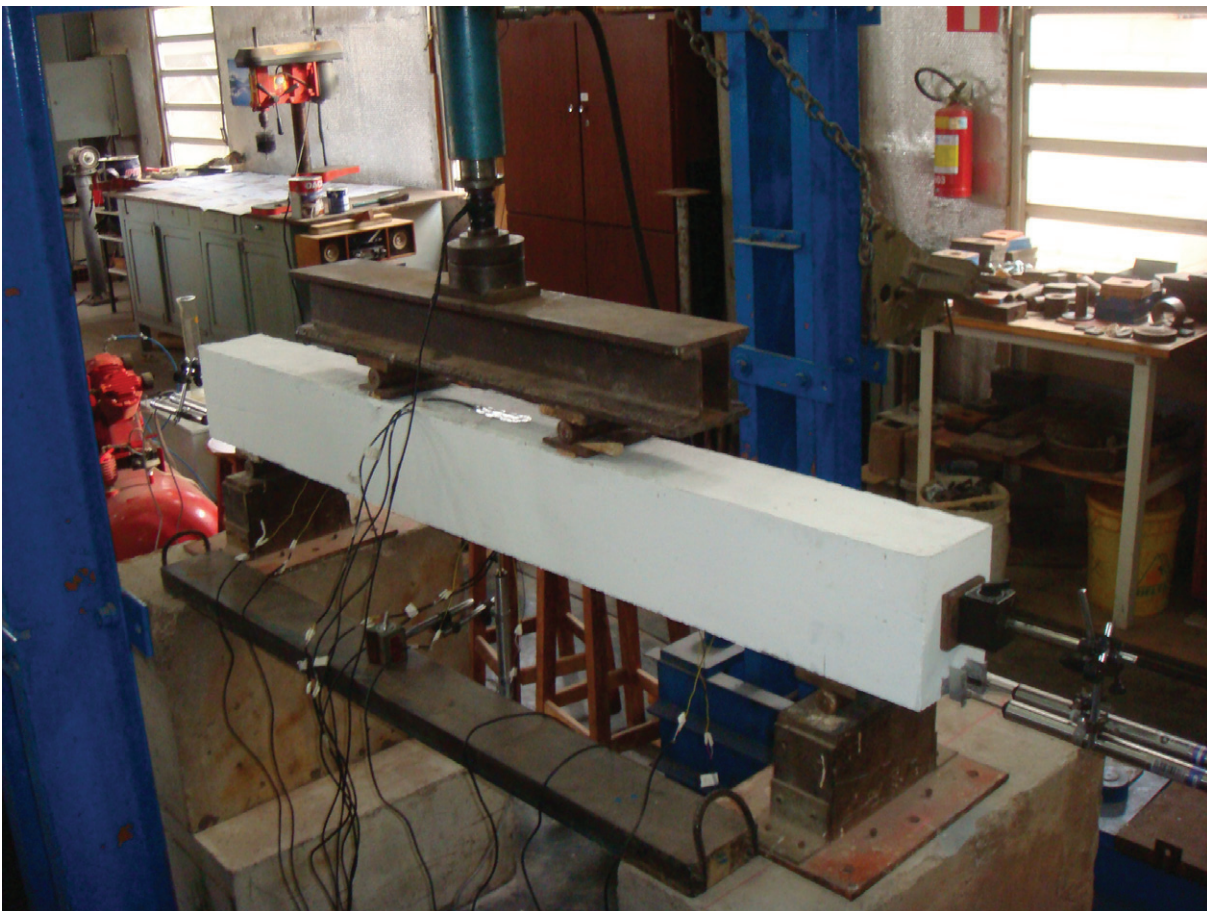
Sistema de aplicação de força durante ensaio da viga reforçada com PRFC.
